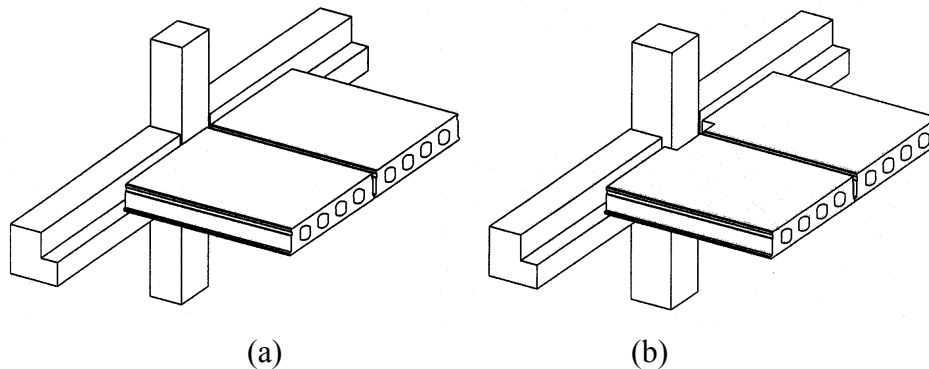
Alternatieve oplossingen voor vloerbalken
